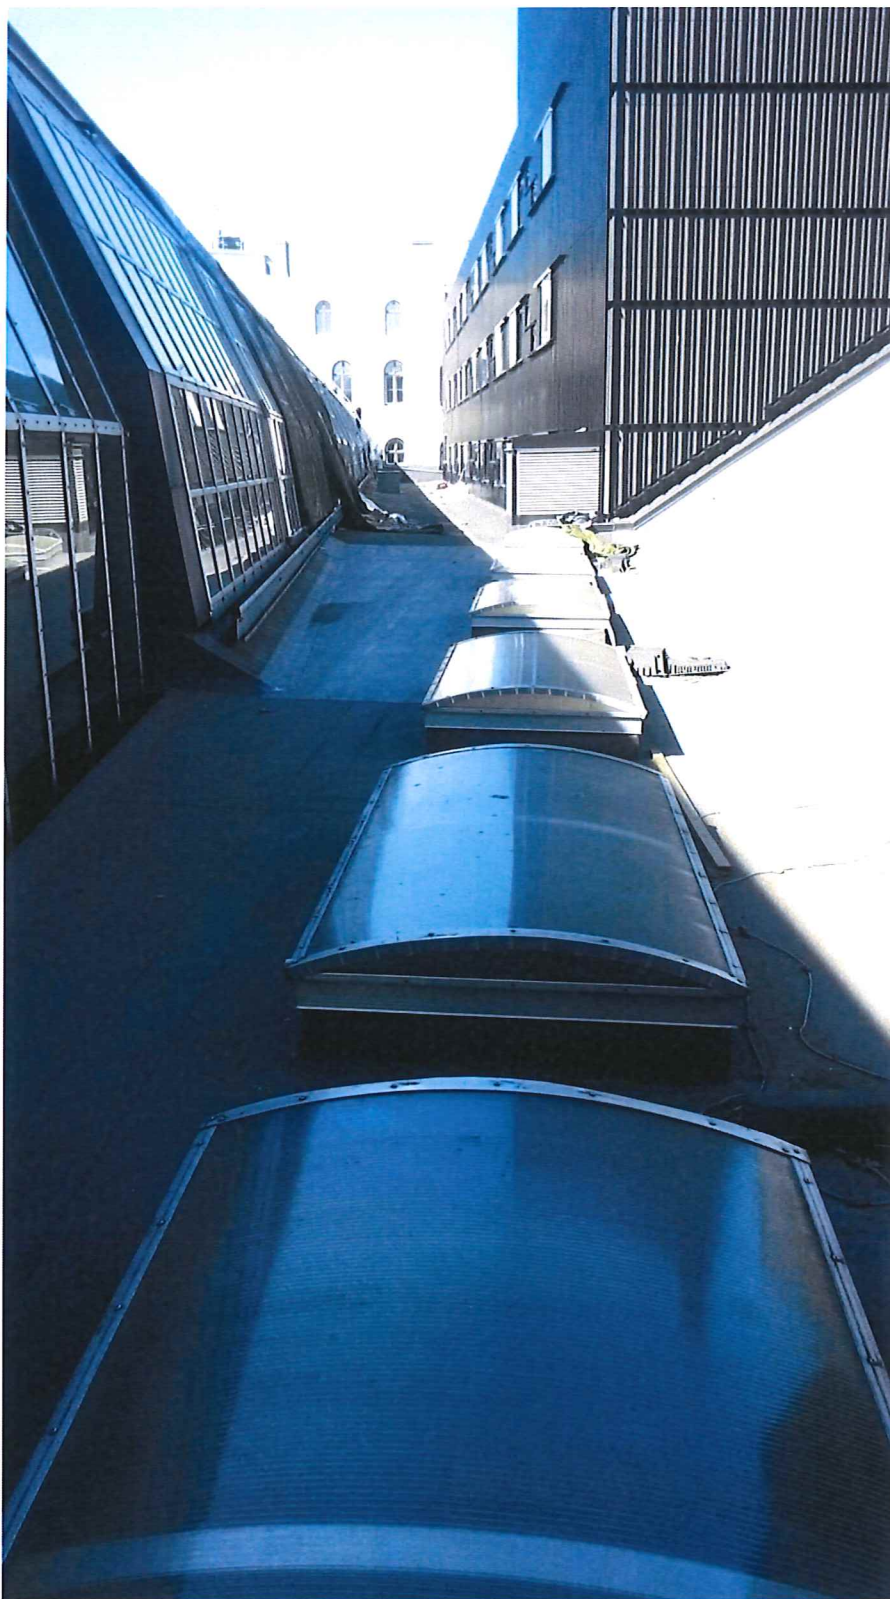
Foto, overgang mot nord (påbygget fasade) (Rambøll)
